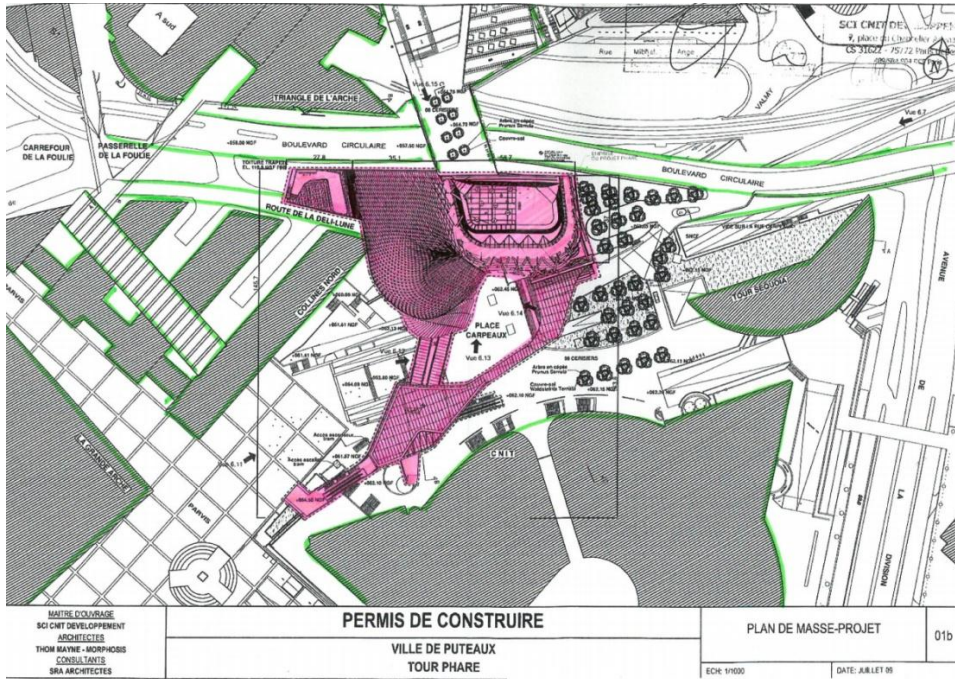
Projection au sol de l'enveloppe du bâtiment : 7 500m² (source : permis de construire)
